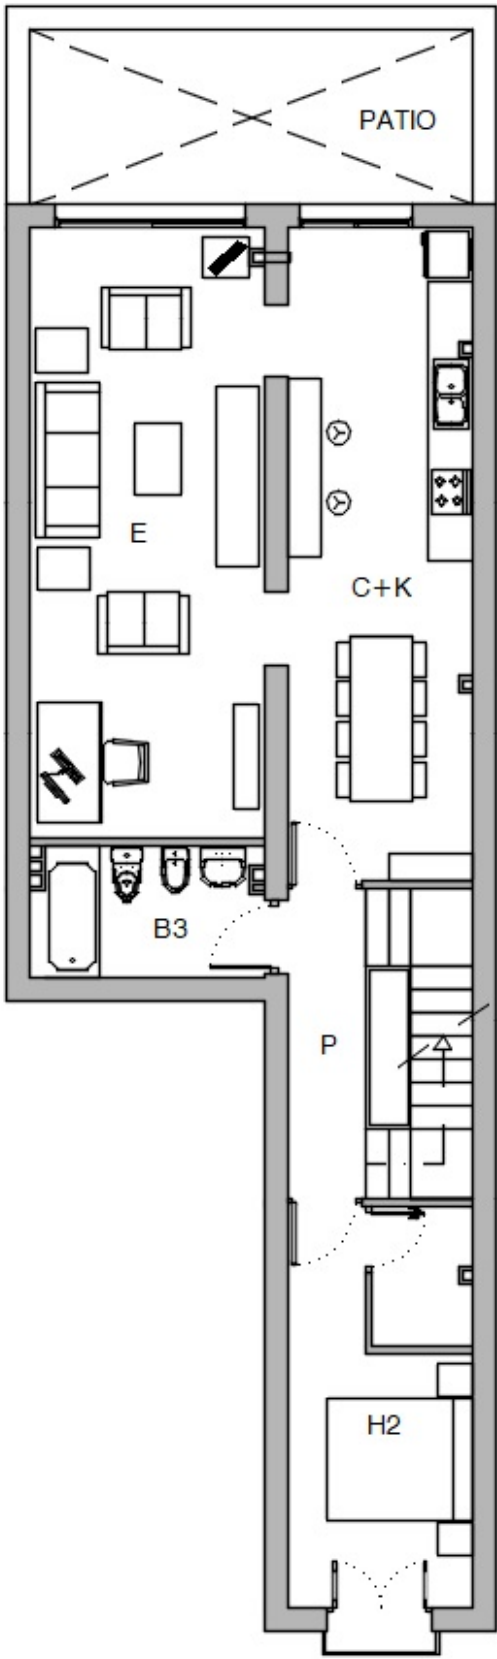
Distribución planta primera / imágenes 3D
